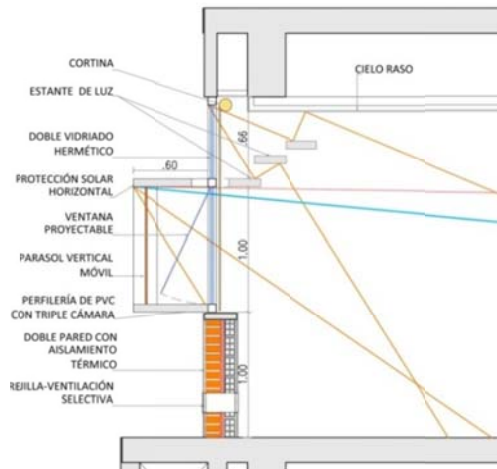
Detalle de carpintería, parasol horizontal y estante de luz (Fachada Norte inclinada) Corte
